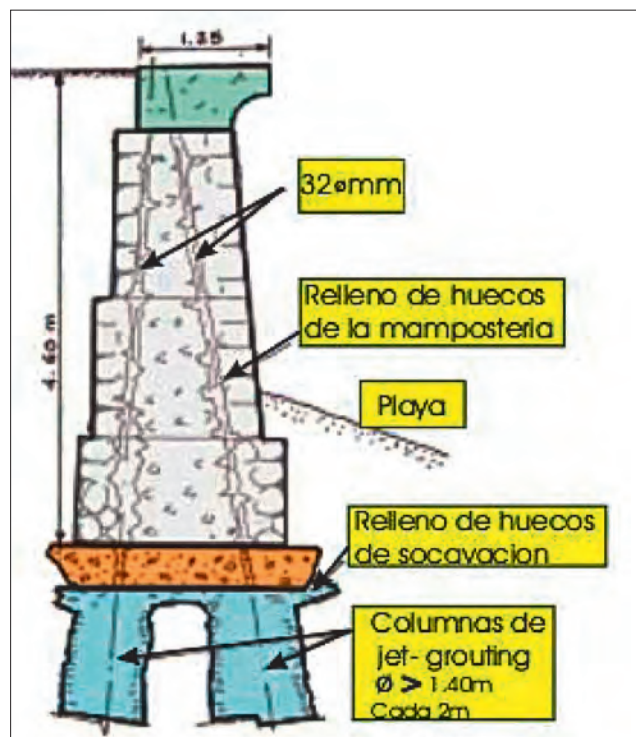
RECALCE MEDIANTE JET-GROUTING DEL MURO DE LA PLAYA DE SAN LORENZO (GIJÓN, ASTURIAS).
